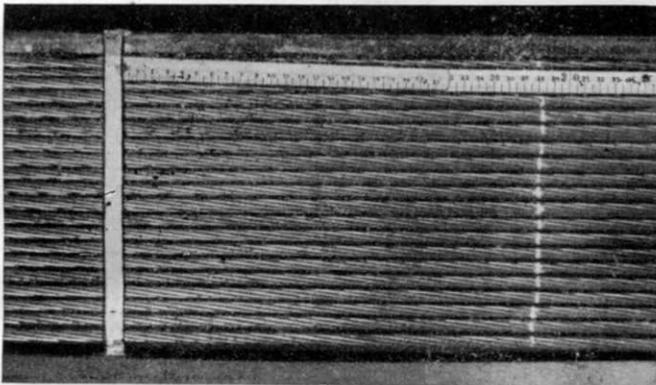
Ponte presso Untermachtal - Spostamento dell'elemento di tensione durante la messa in trazione.
